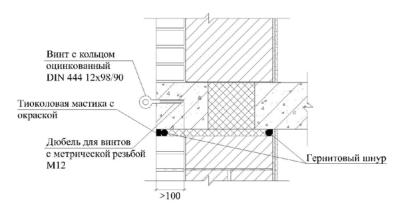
Крепление навесных устройств к фасадам стен
